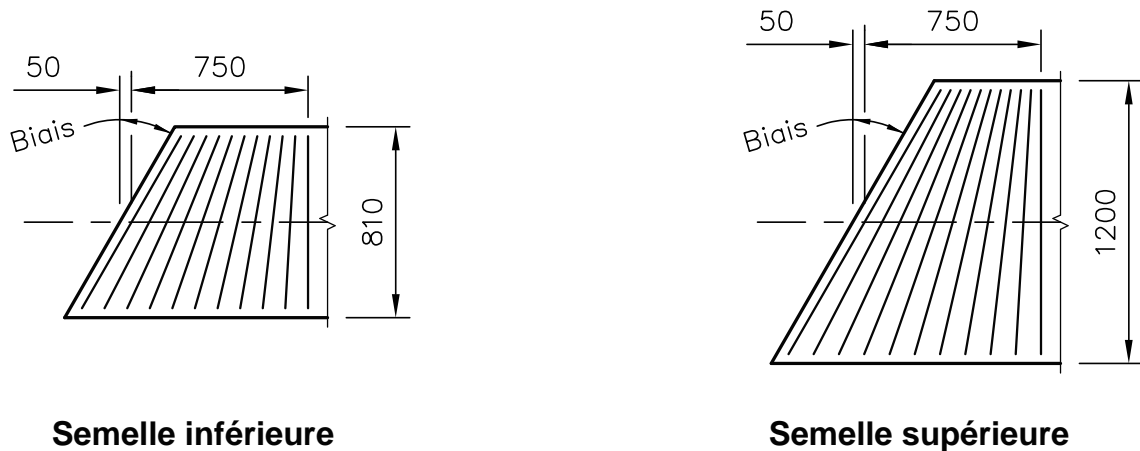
Disposition des armatures transversales aux extrémités des poutres avec biais d'au plus 30°
